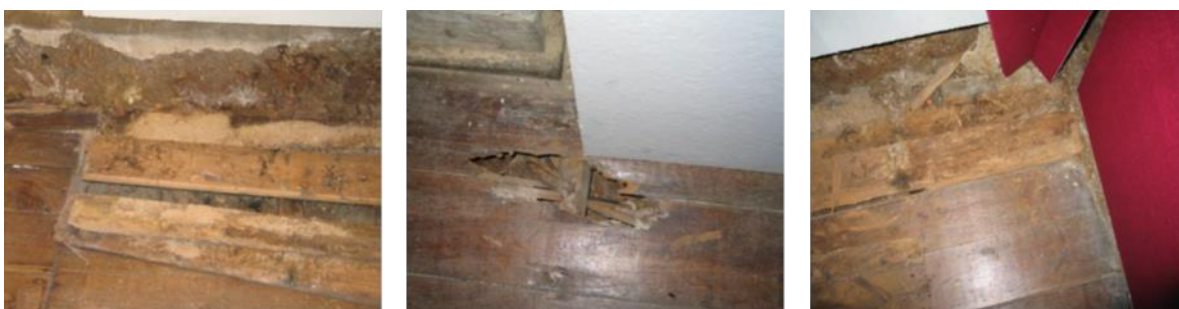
Mau estado de conservação do pavimento de madeira do Coro Baixo
